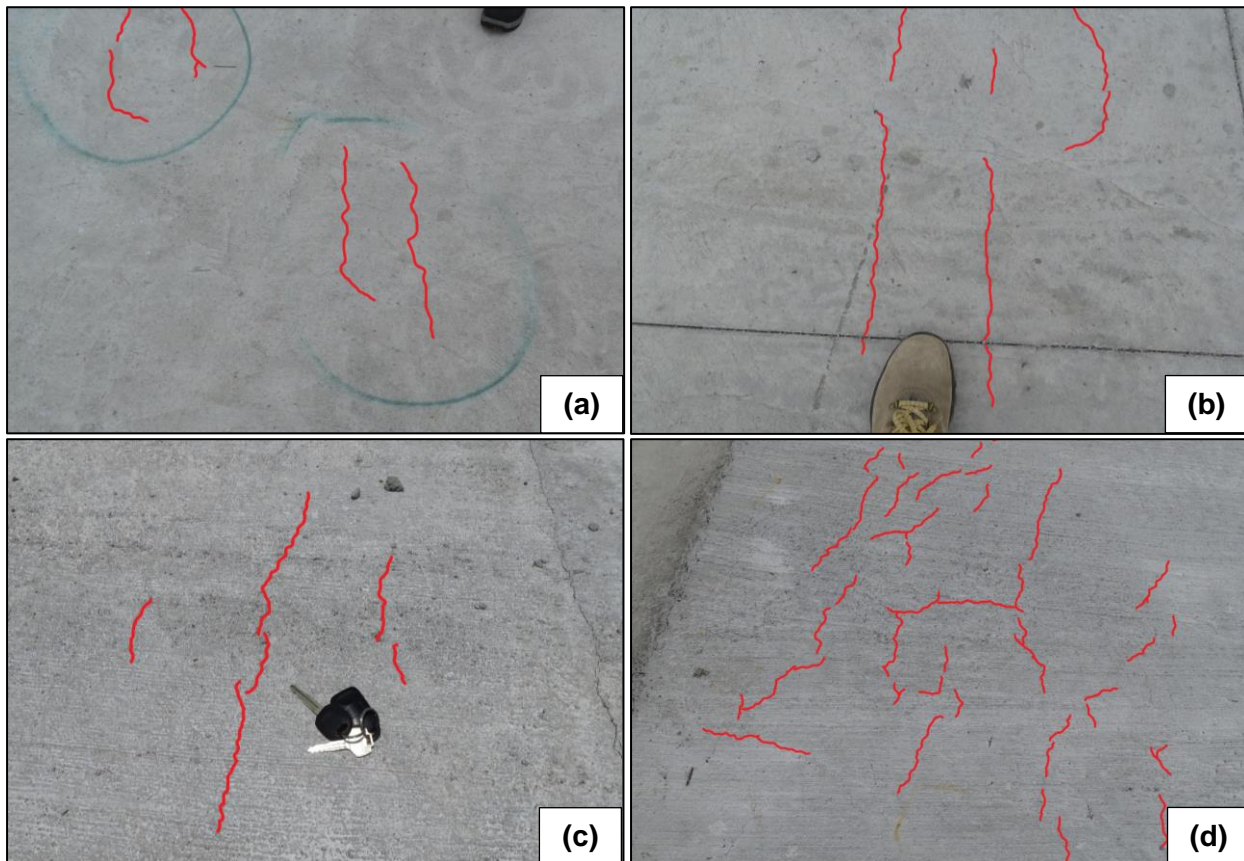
Ejemplos de fisuras en la superficie de las losas del viaducto.
